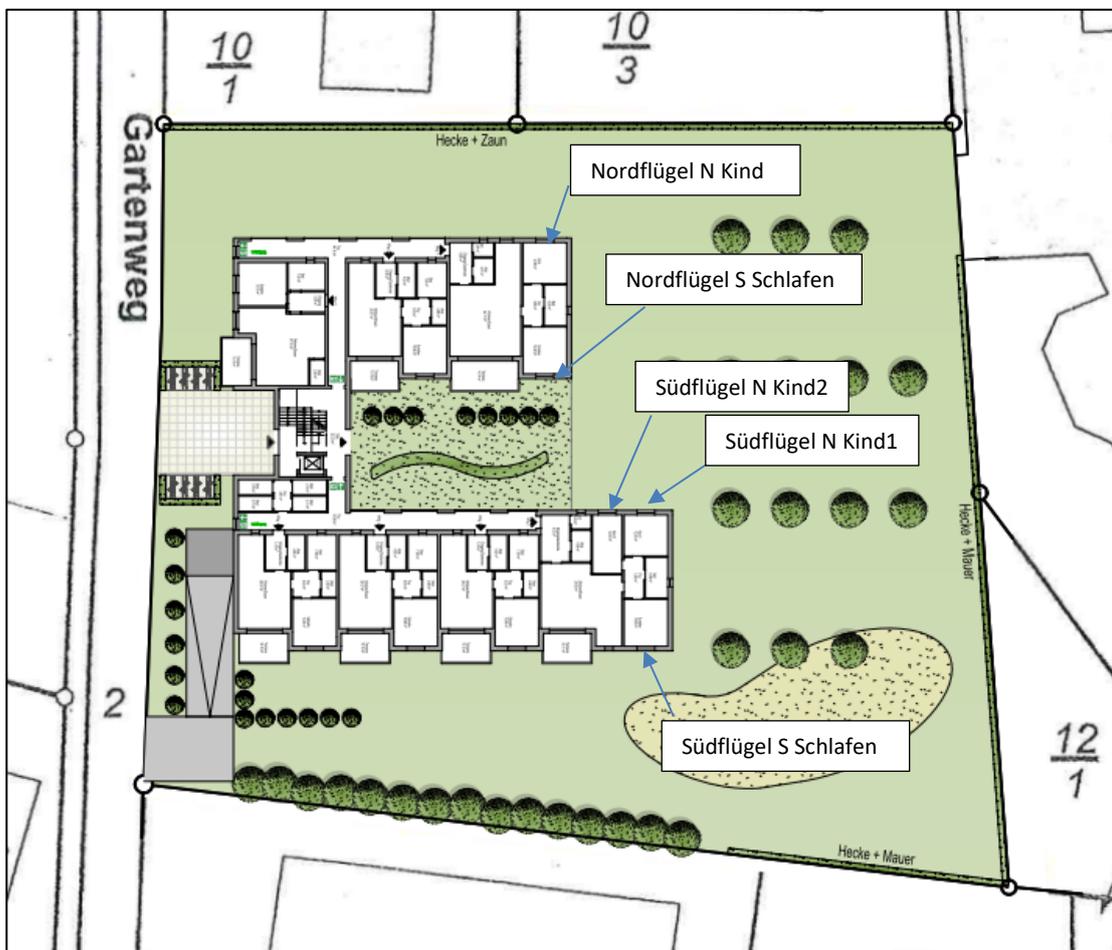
geplante Anordnung [17] und gewählte Immissionsorte (genordet)
